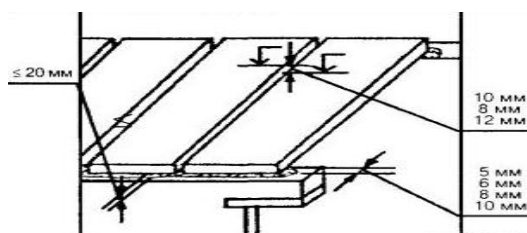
Схема допустимых отклонений при монтаже плит перекрытия
